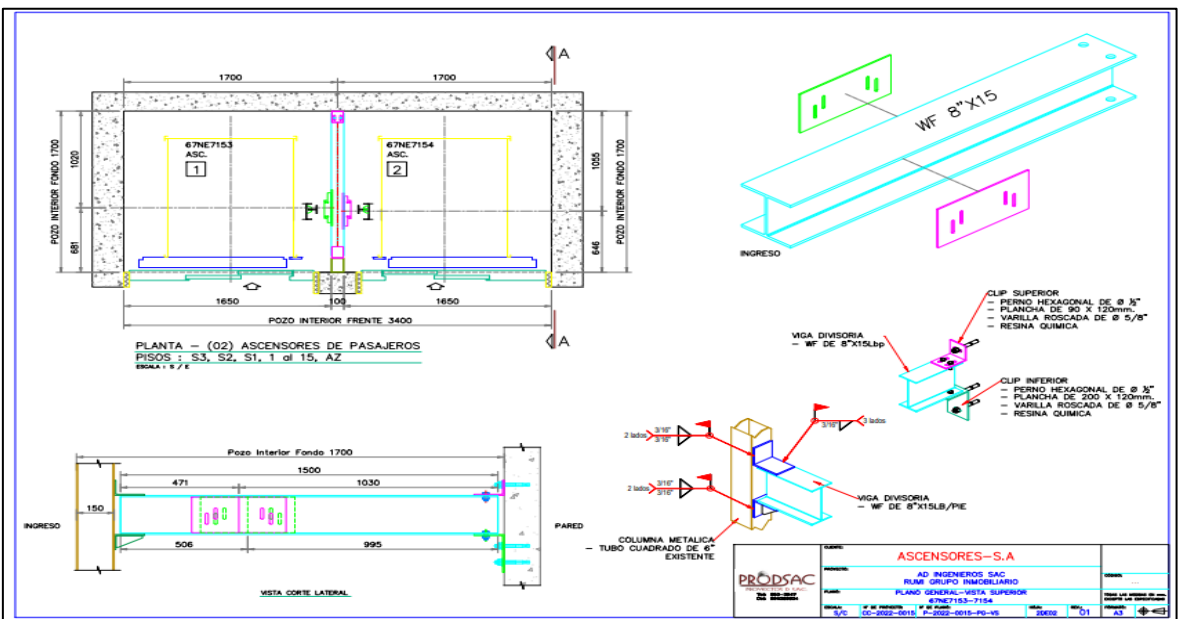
Vista de planta del plano de montaje de vigas divisoras proyecto 2
